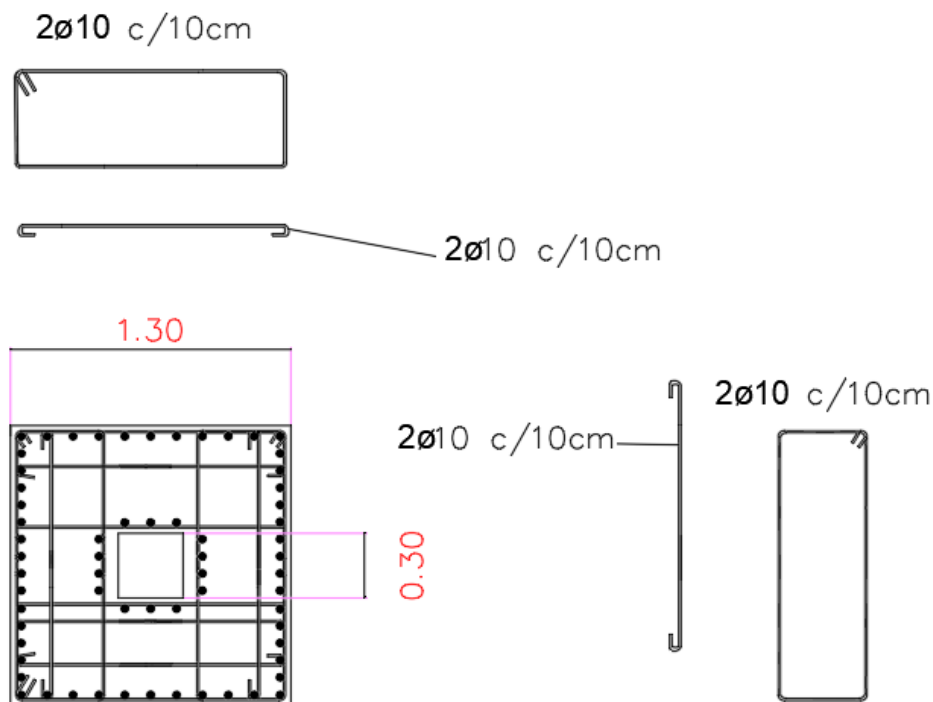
Armadura transversal en las zonas no extremas de la parte intermedia de las pilas (H = 24 m a 47 m).
